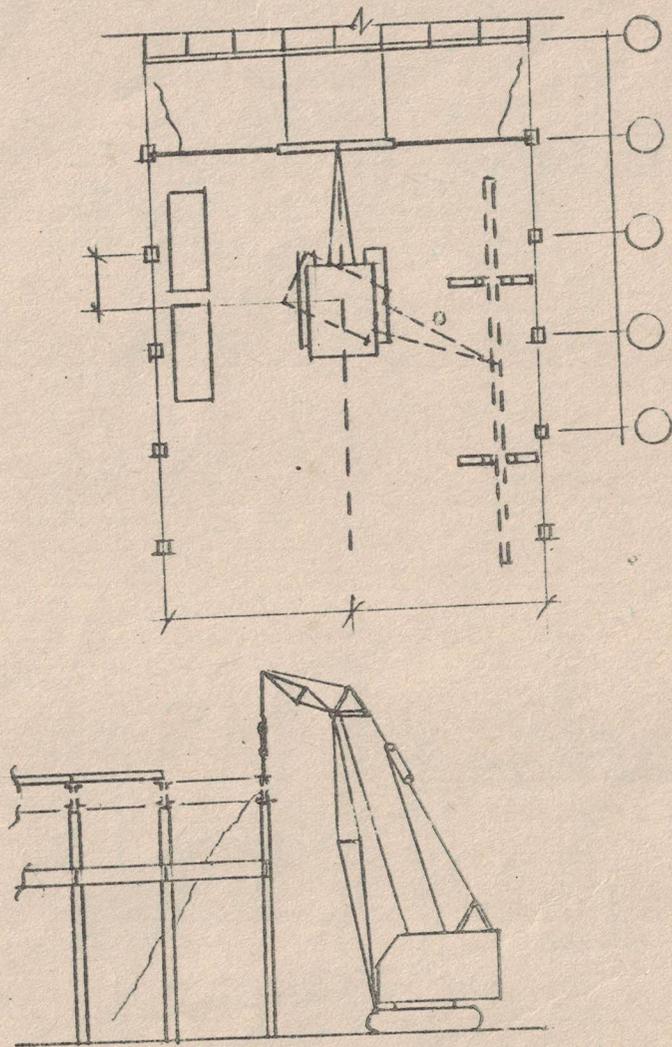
Схема монтажа стропильных ферм и плит покрытия
